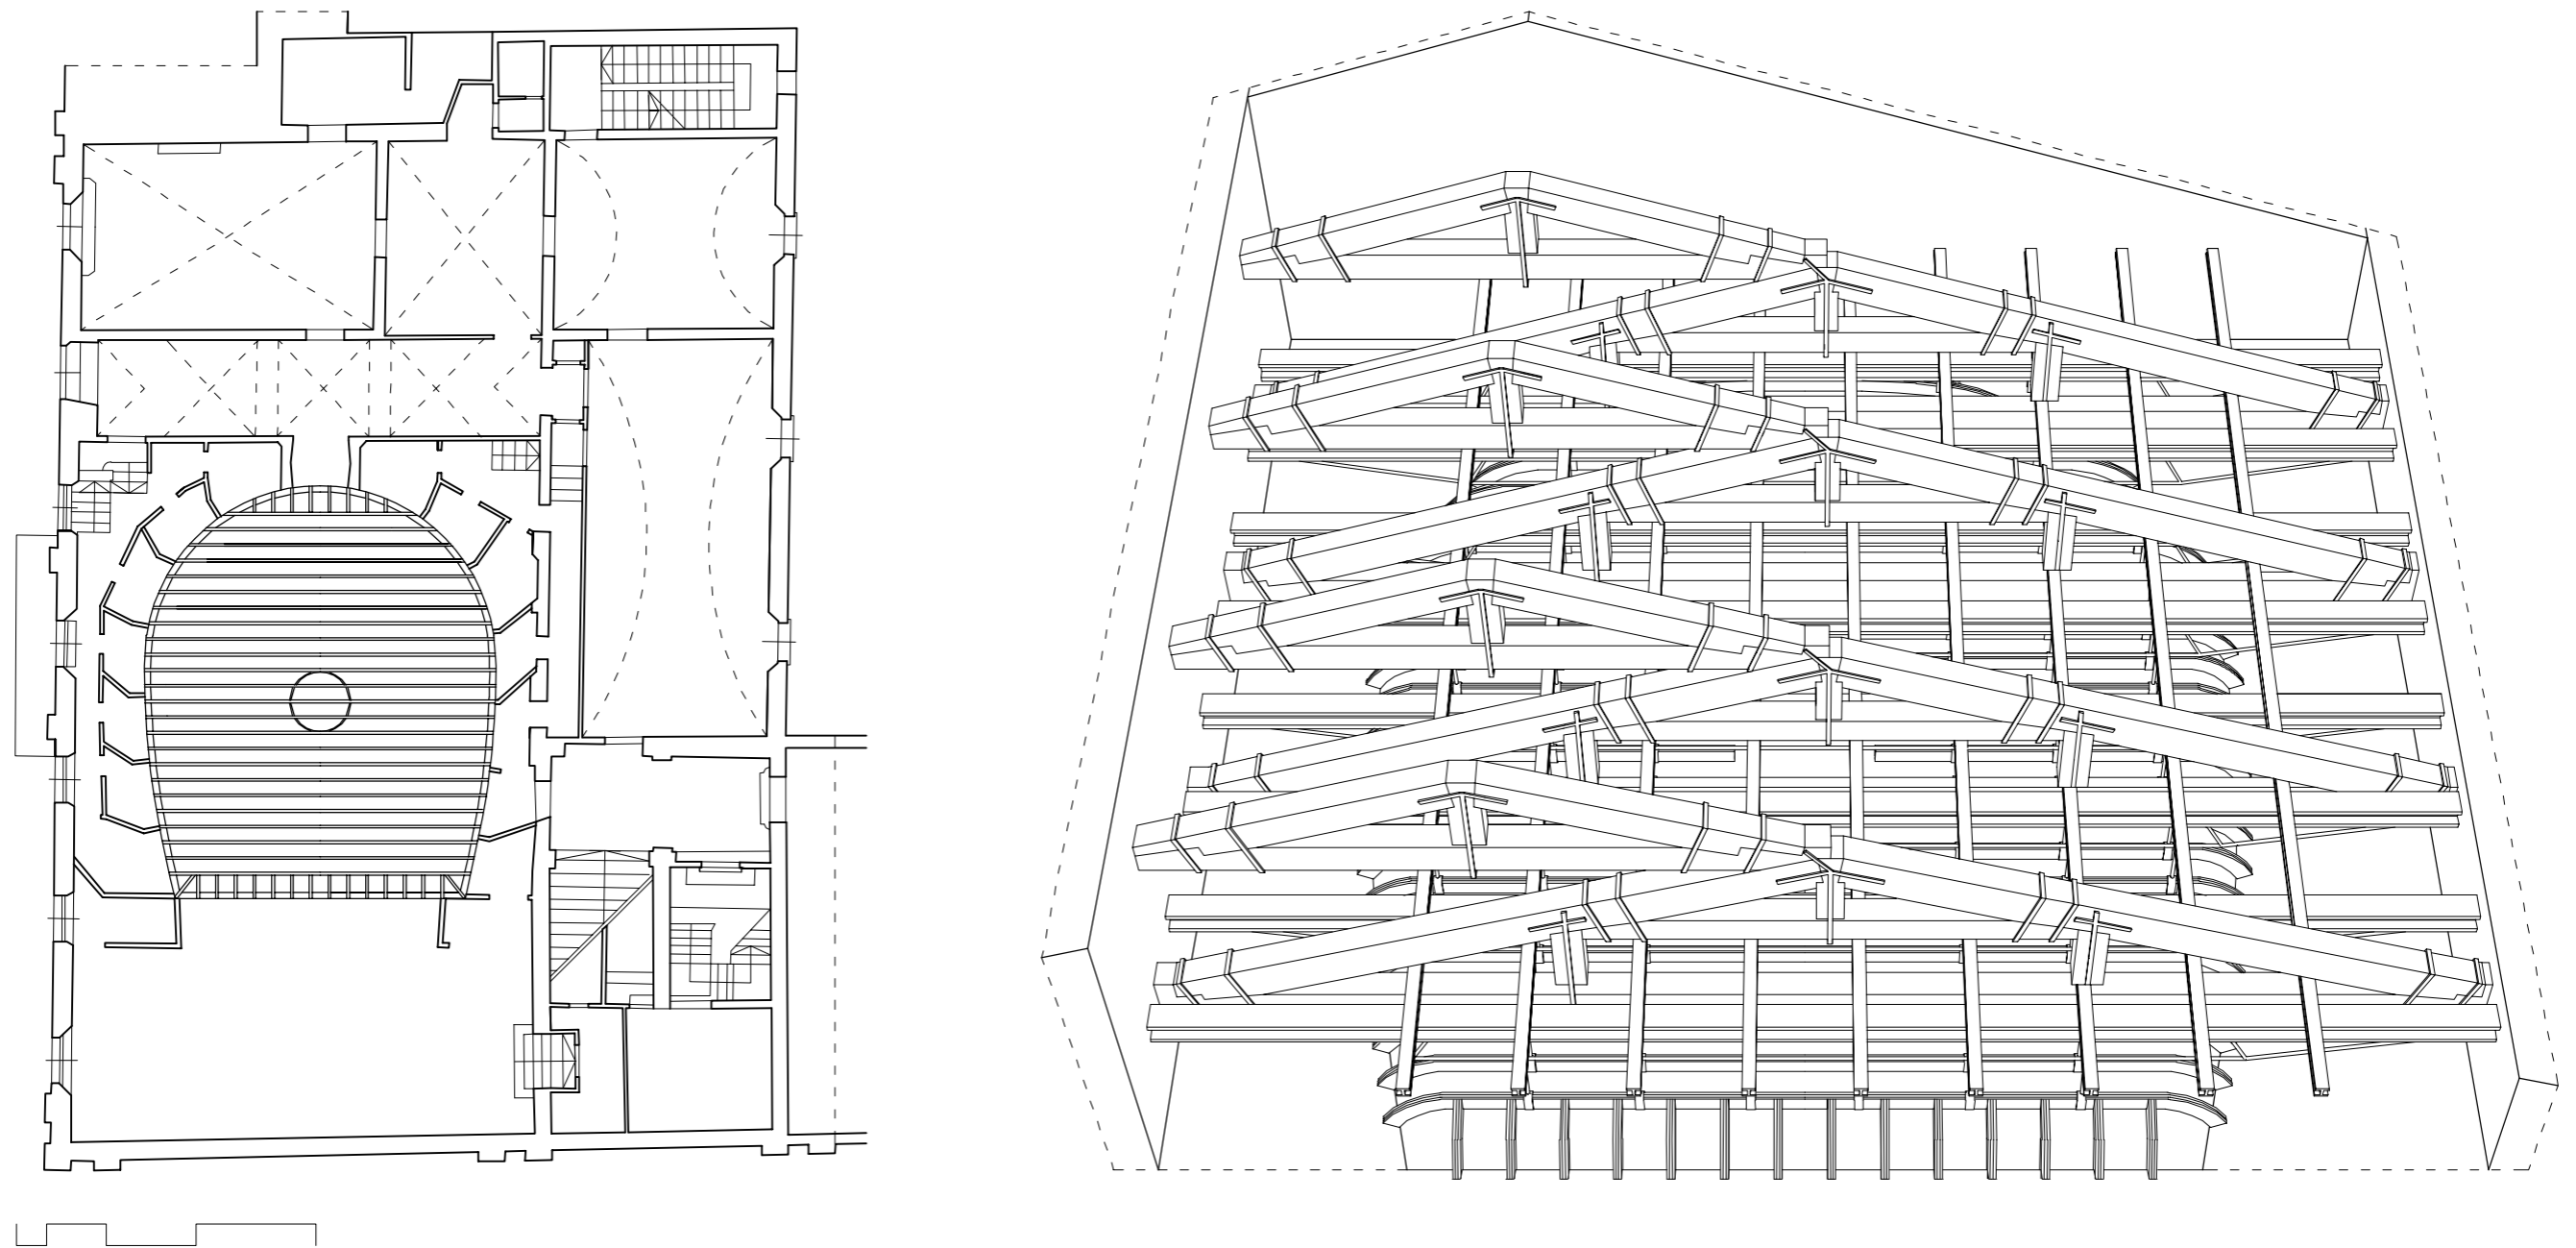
Teatro Comunale “Alice Zeppilli” di Pieve di Cento. Pianta del primo ordine di palchi (ridisegno) con proiezione del plafone; rappresentazione prospettica del sistema di copertura della sala.
